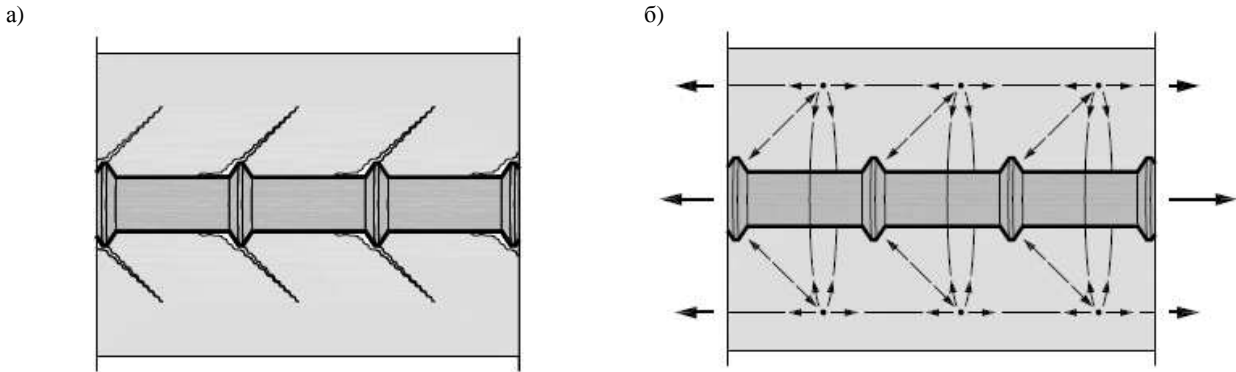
Сцепления арматуры с бетоном [13]: а) развитие наклонных трещин; б) механизм перераспределения усилий между арматурой и бетоном
